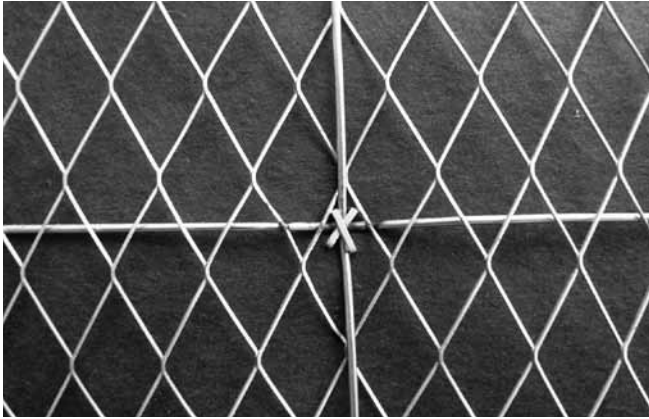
千里聖三一教会のラスモルタル外壁の施工状況 (1)
